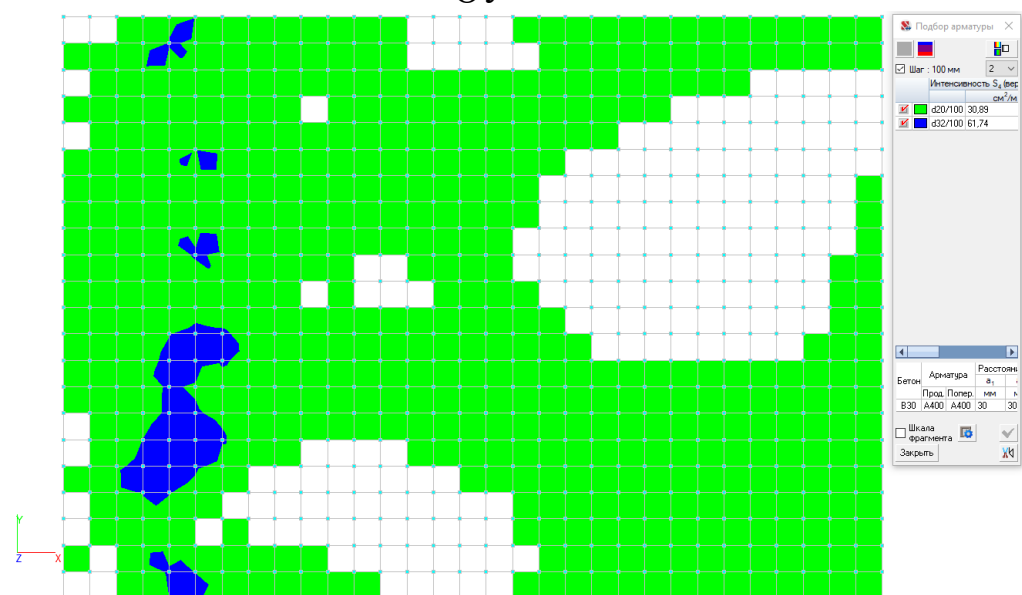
Интенсивность армирования верхнего пояса плиты перекрытия по ОУ
